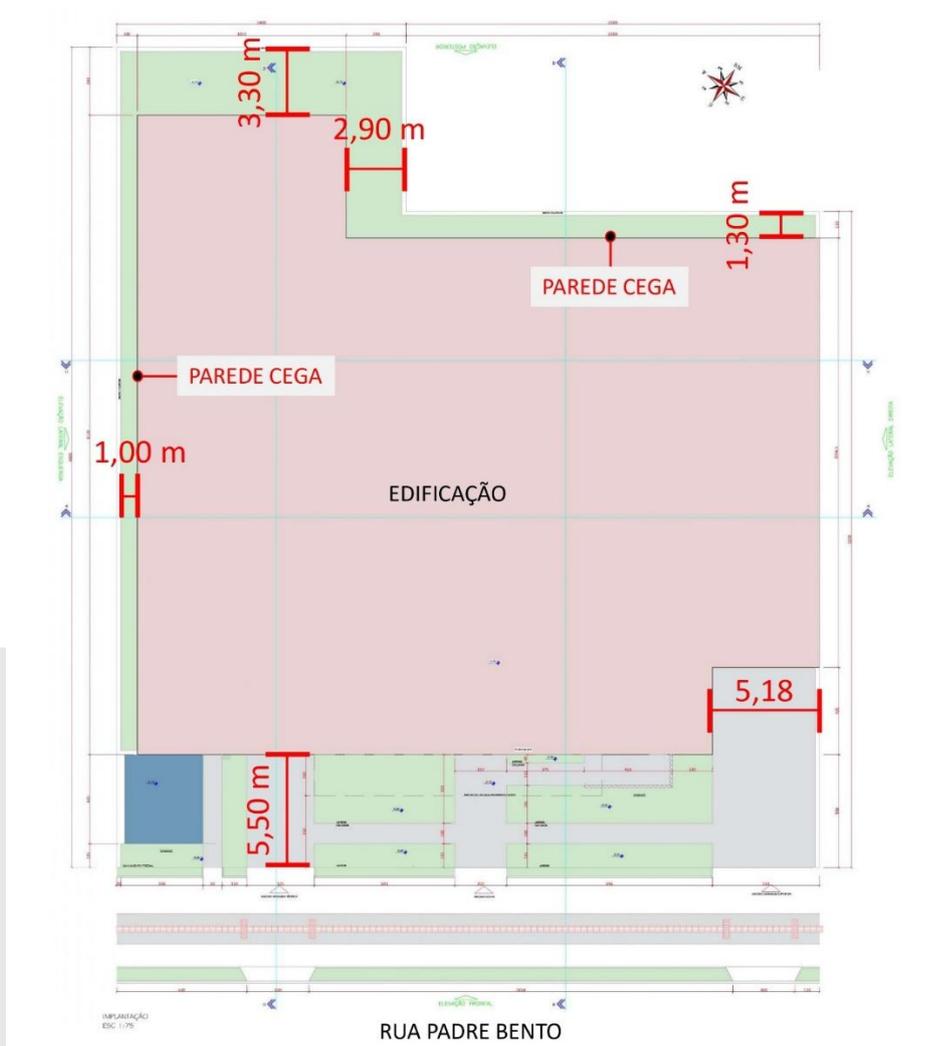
Implantação de projeto com recuos. Fonte: Merhy Engenharia, 2025, editado por SYDOR arquitetura, 2025.
